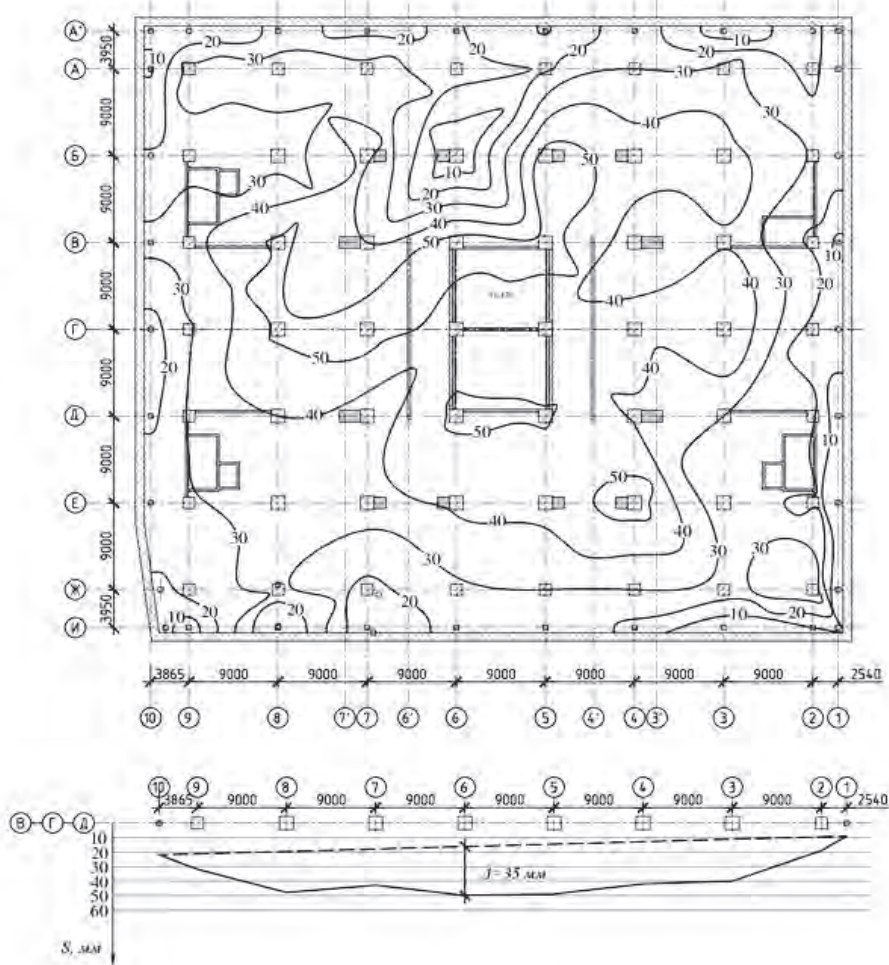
Изополе вертикальных перемещений фундаментной плиты с учетом исполнительной геодезической съемки 1999 г. (сверху); график прогиба фундаментной плиты (внизу)
